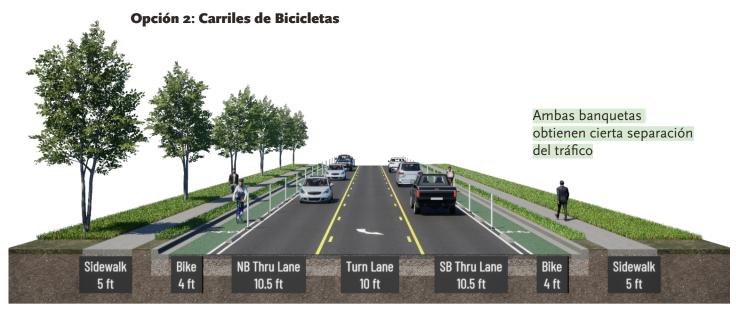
Alternativas para Rainbow Boulevard Entre la Avenida 47 y Shawnee Mission Parkway
